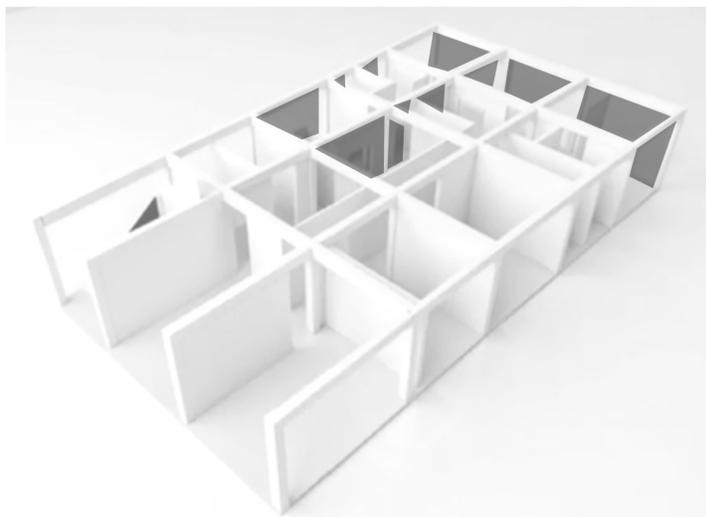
Ubicación de reforzamiento en muros en planta baja. FUENTE: Imagen propia.
